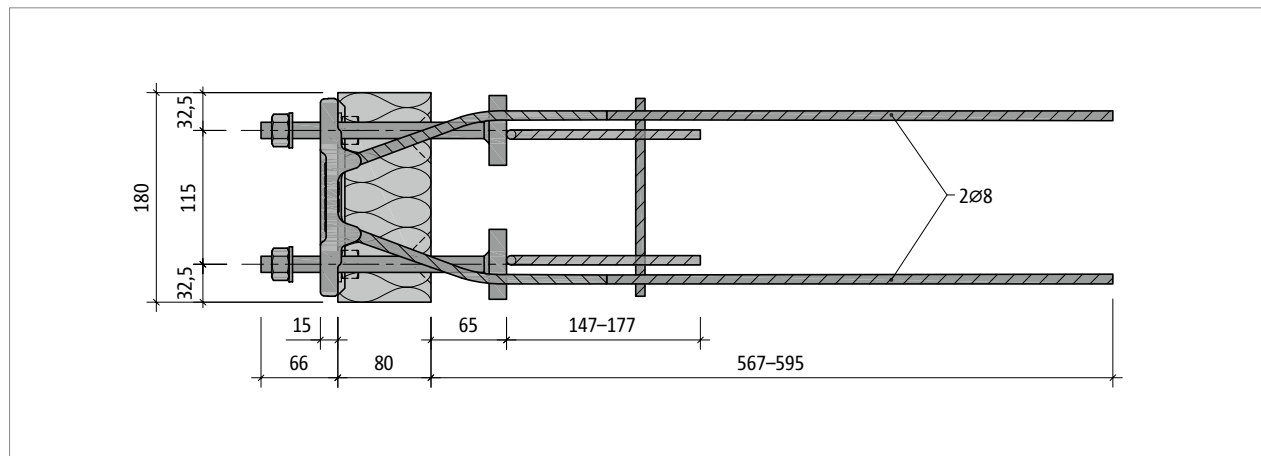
Schöck Isokorb® T type SQ-V1 : vue en plan
